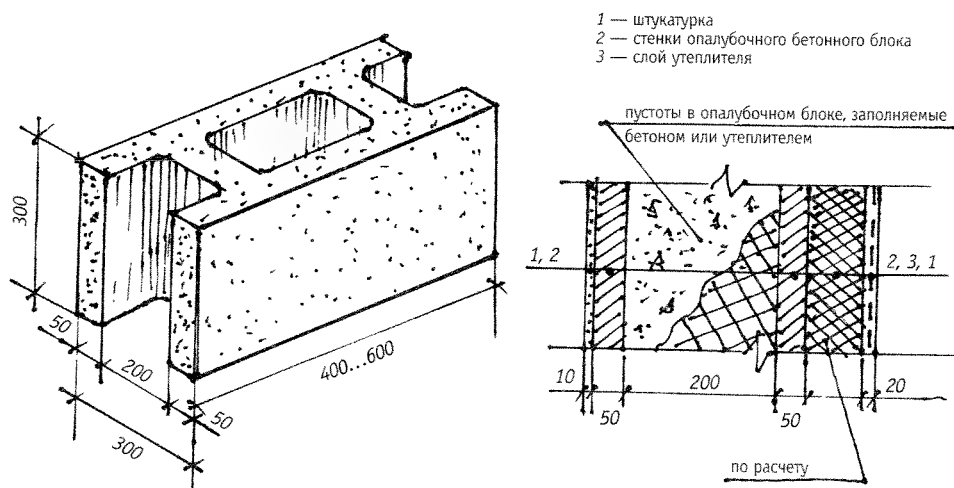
Варианты несъемной опалубки для малоэтажных зданий
